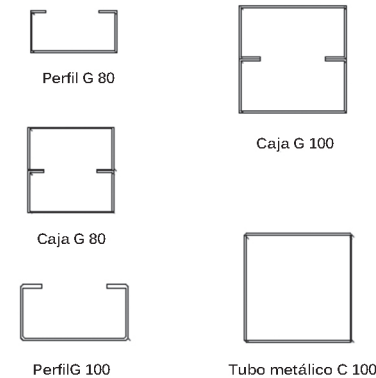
Perfiles metálicos utilizados en la armadura de una cubierta.
